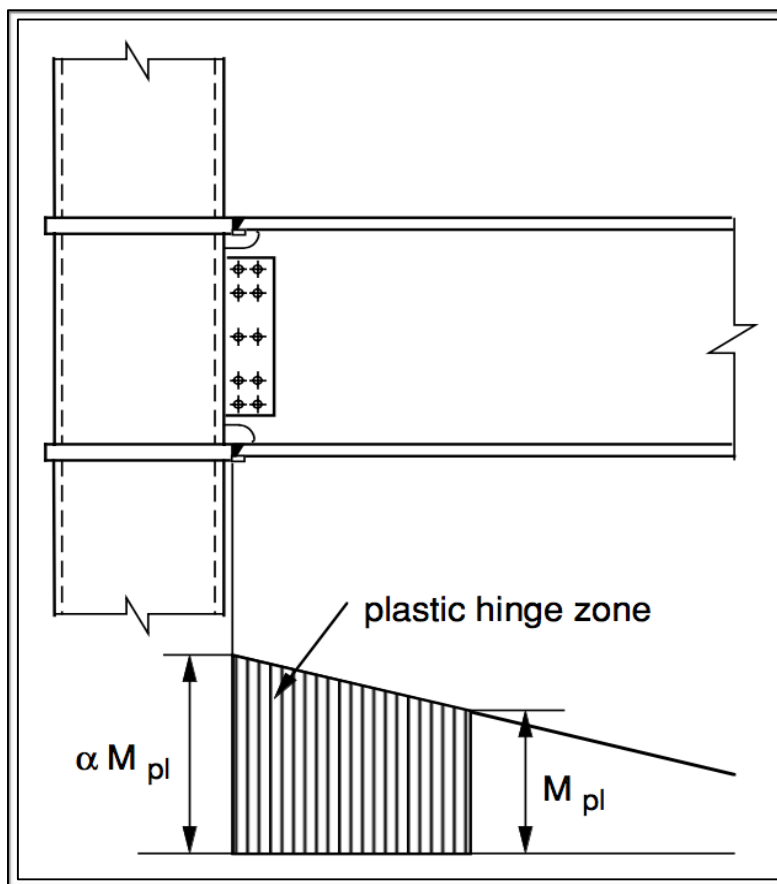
Zona de rotula plástica. (Packer, DESIGN GUIDE FOR STRUCTURAL HOLLOW SECTION COLUMN CONNECTIONS, 2004)
